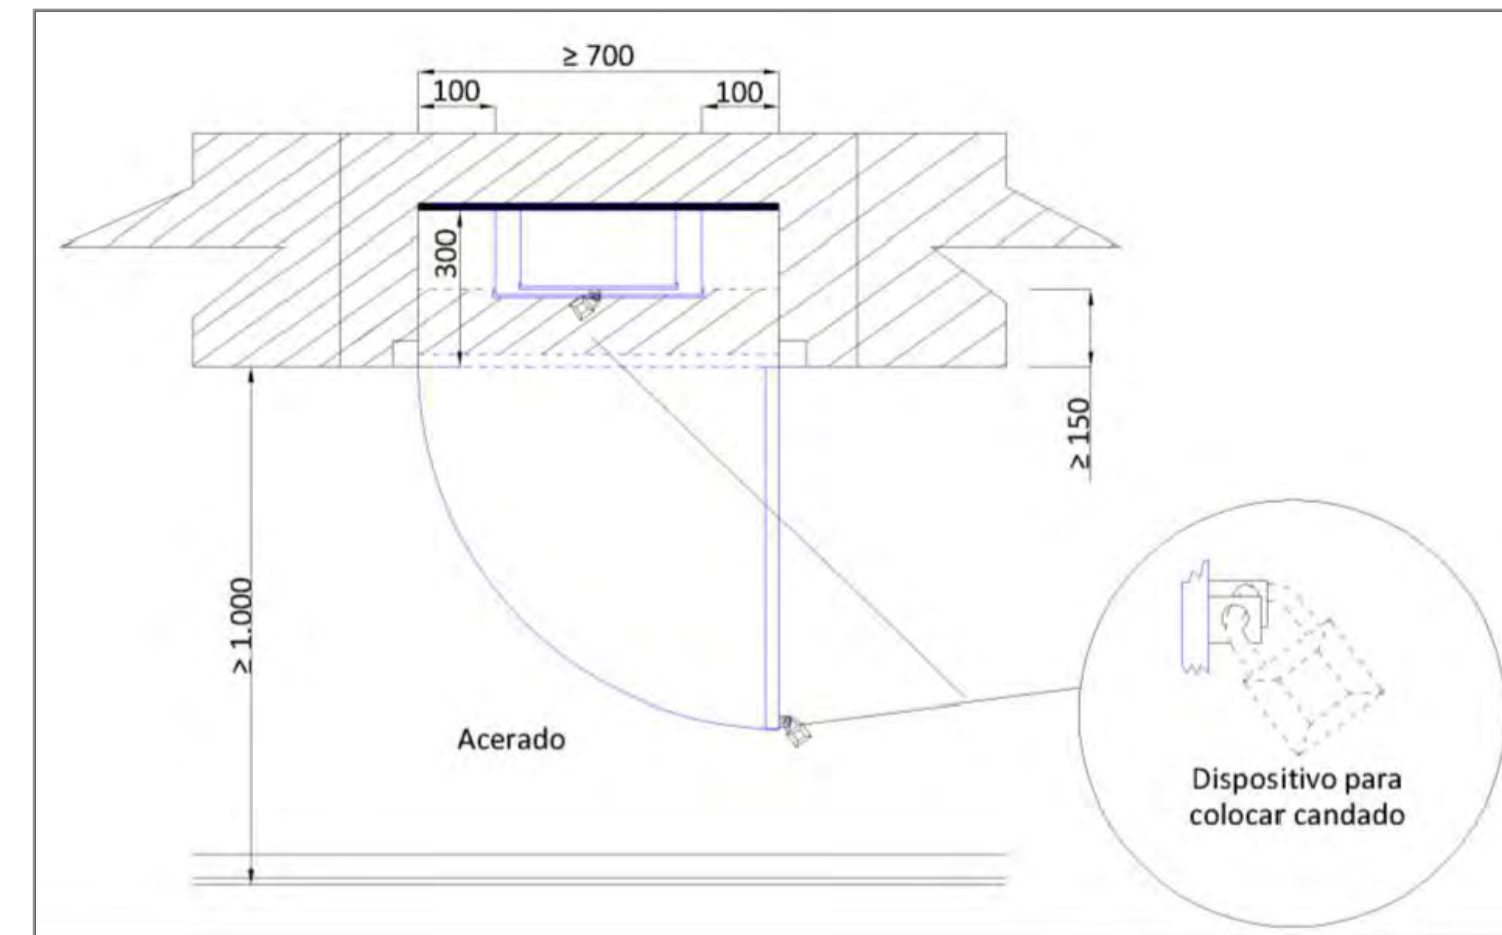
Instalación CGP y CS montaje vertical. Planta.
